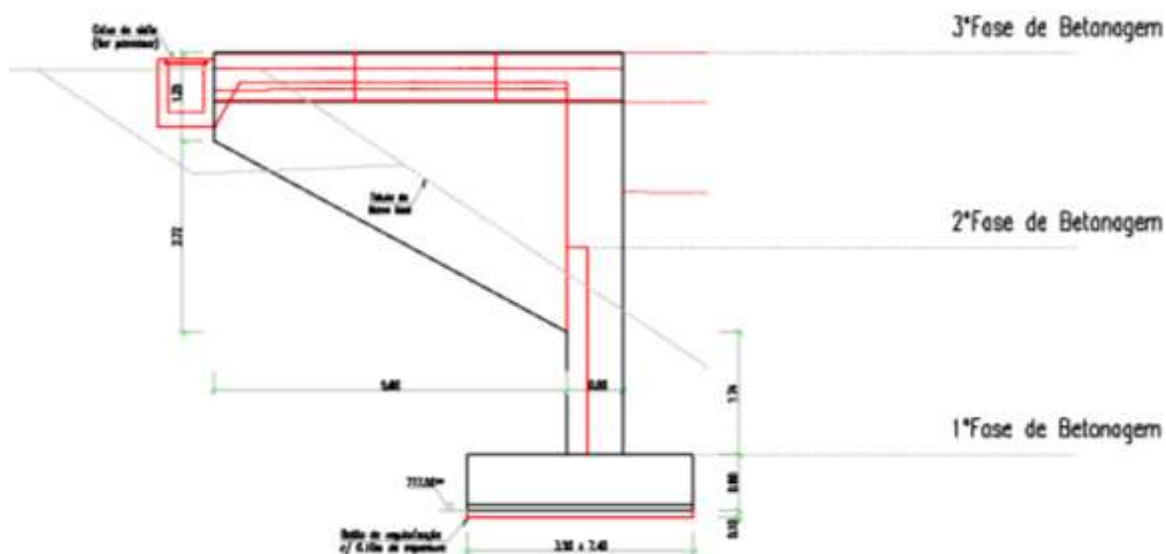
Identificação no alçado transversal das fases de betonagem. [Adaptado de 20]
